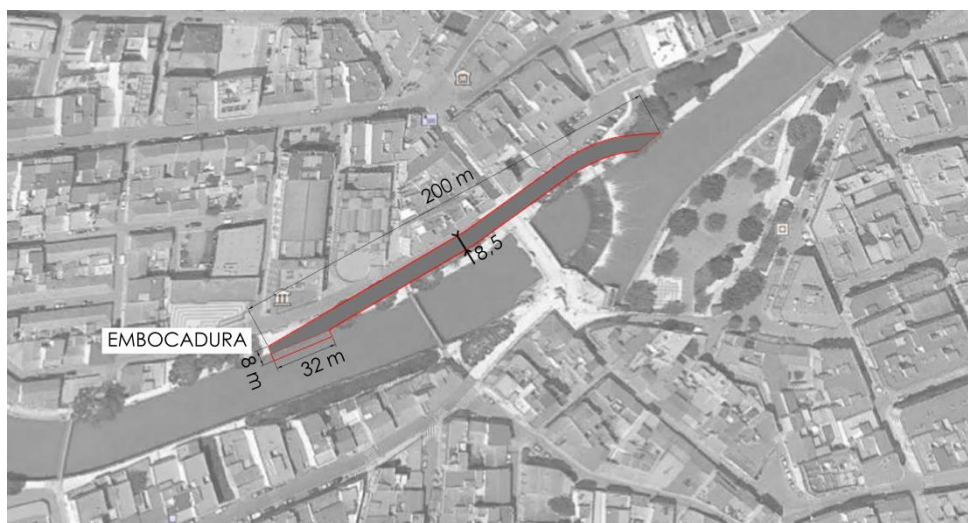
Planta del by-pass sobre mapa. (Fuente: propia con AutoCad)
